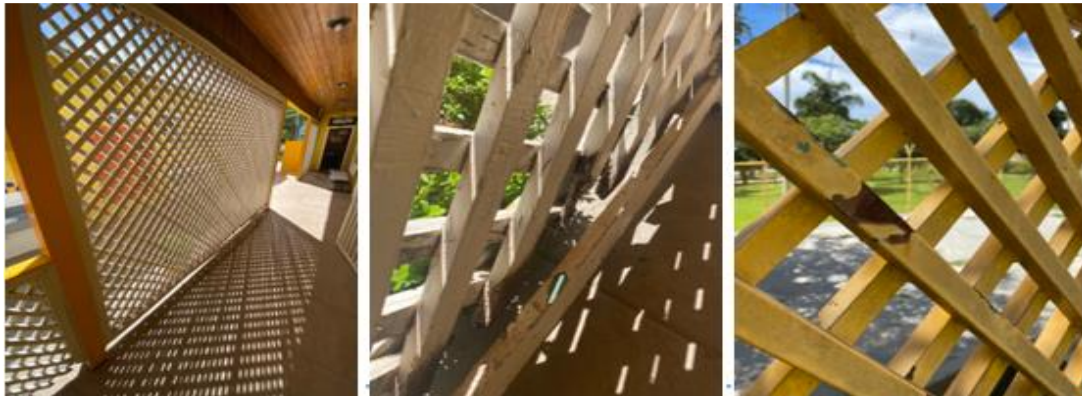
Treliça original em madeira e Treliça substituída em metal (FNDE, 2021)
